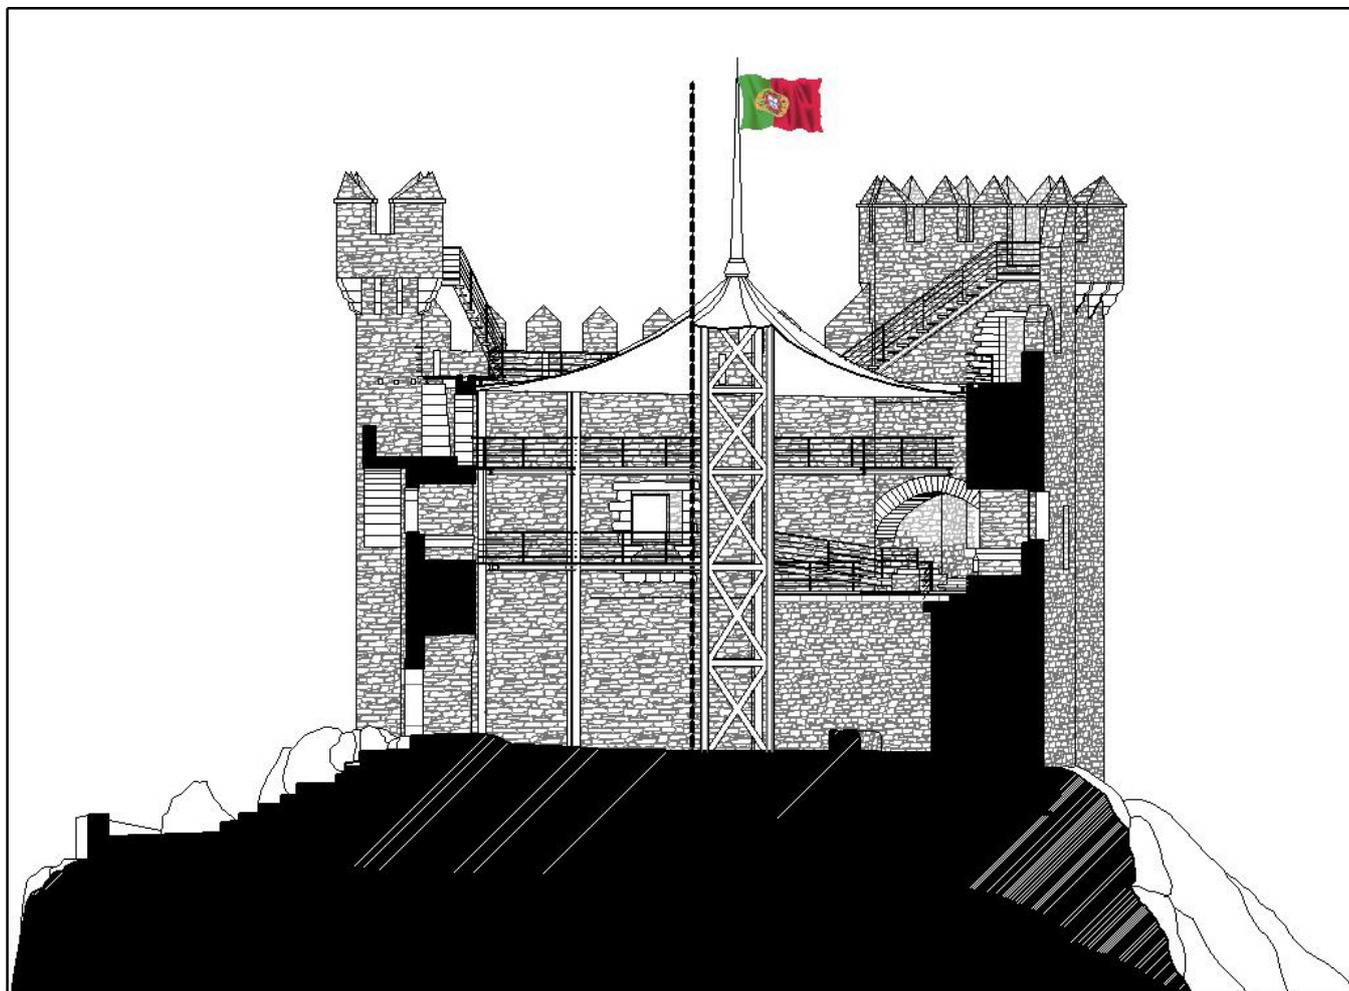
Corte proposto para a muralha poente do castelo de Penedono, mostrando o elevador panorâmico
